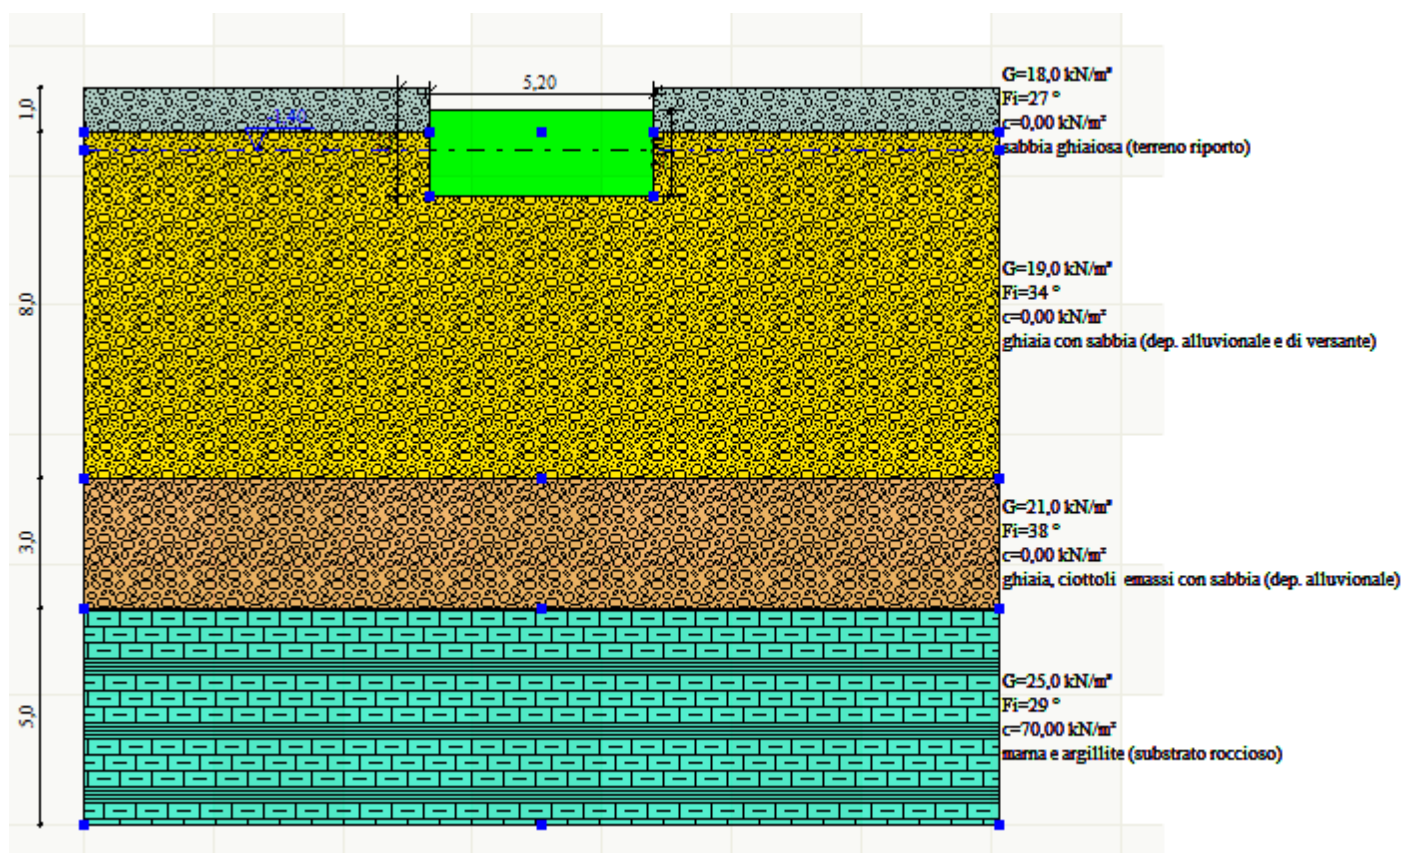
Modello geotecnico del terreno utilizzato per le analisi (la fondazione è posta a -2,5m dal piano campagna e la falda a -1,4m da p.c.).
